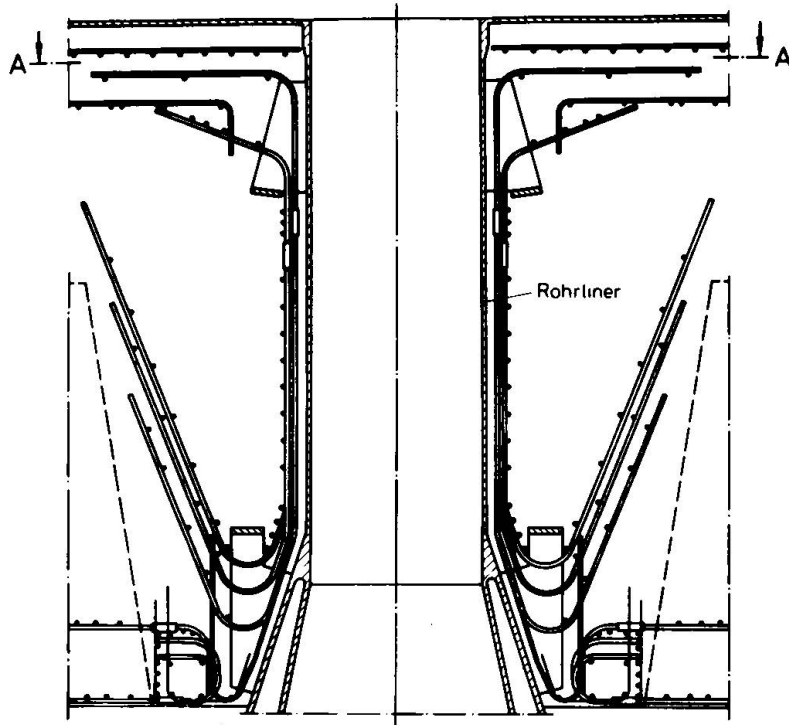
Youite eines Spannbetonbehälters bei Verwendung von Stahlfaserbeton
